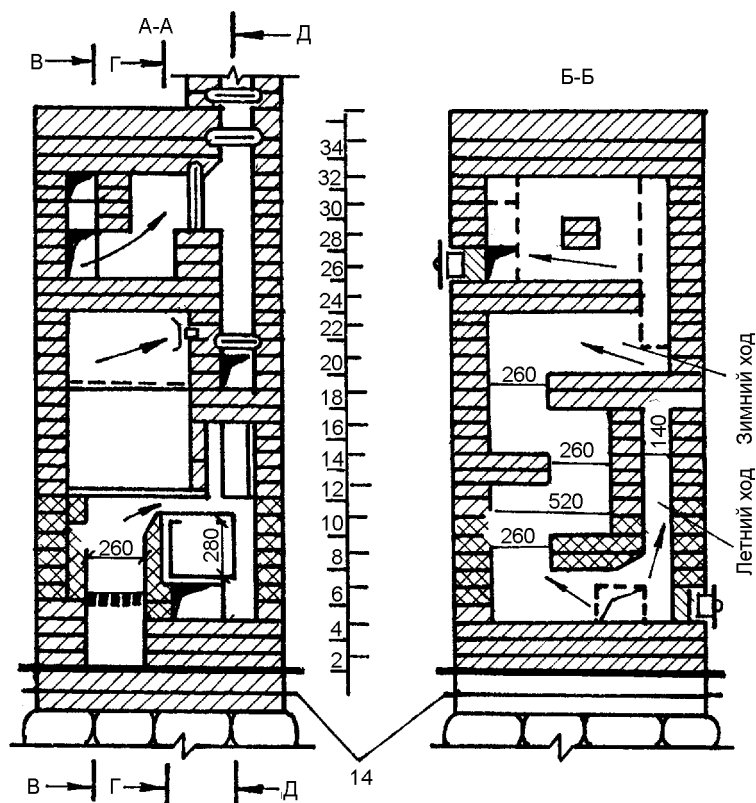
Устройство отопительно-варочной печи И. Ф. Волкова без камеры для выпечки хлеба
